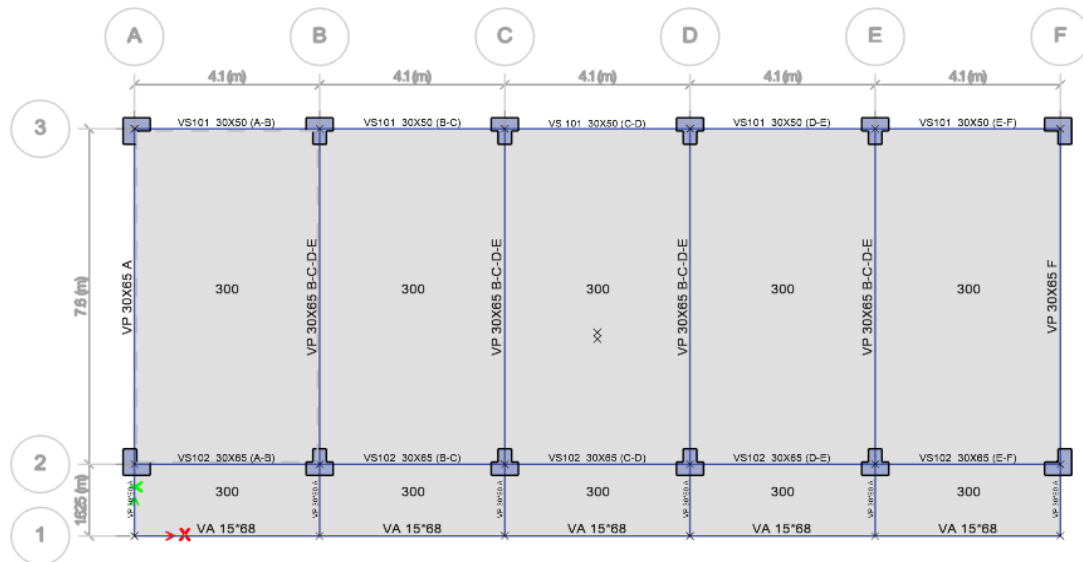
Planta del Modelado en el Software Etabs del Módulo VI
